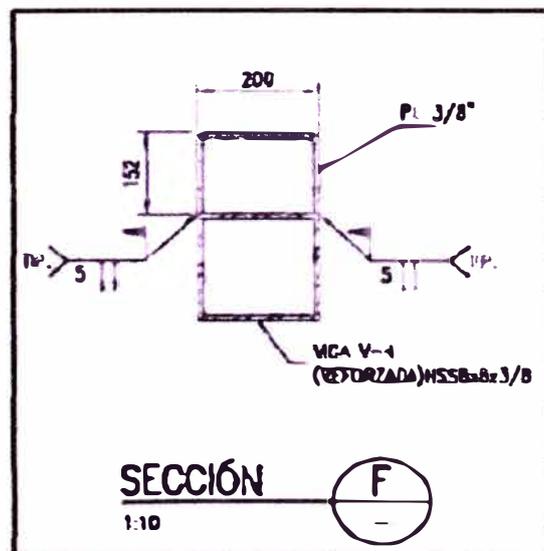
Detalle de reforzamiento en Viga V-4
